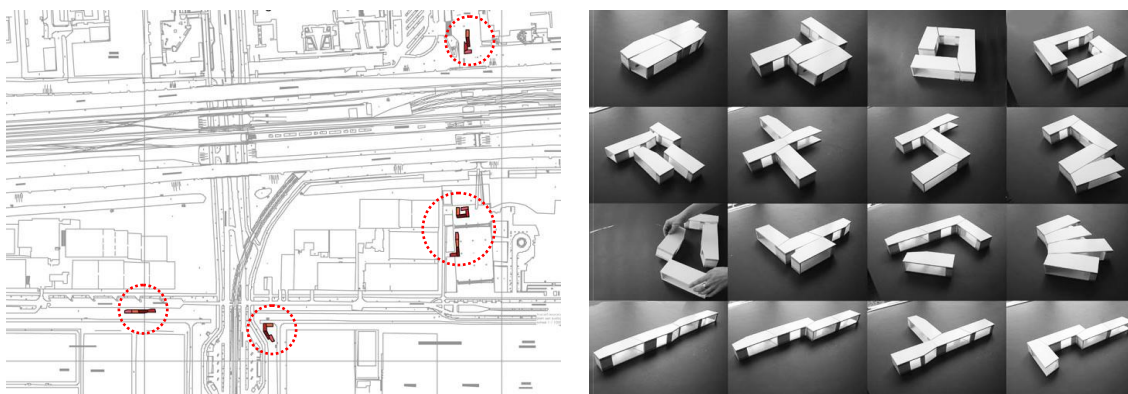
"KA", planta de implantação e esquemas conceptuais.
